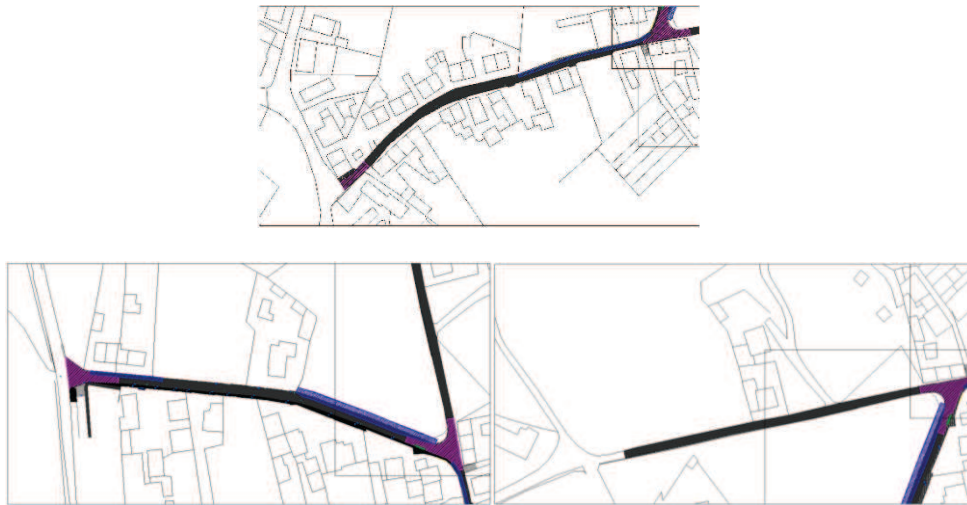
Trabalhos de pavimentação na Rua do Outeiro e Rua do Salgueiral.
